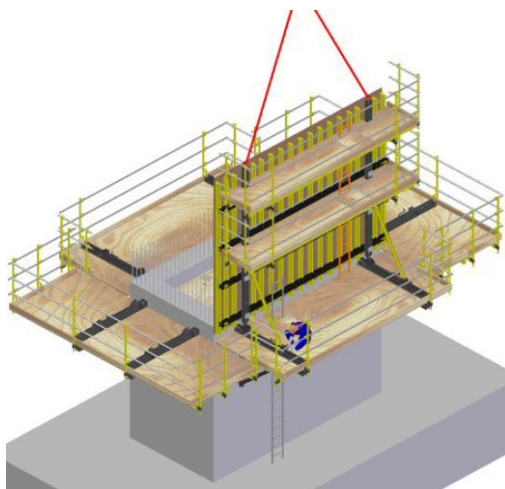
u. Detalle de elevación del paño exterior. Recuperado de: Ulma Construction, *Instrucción técnica de montaje.
